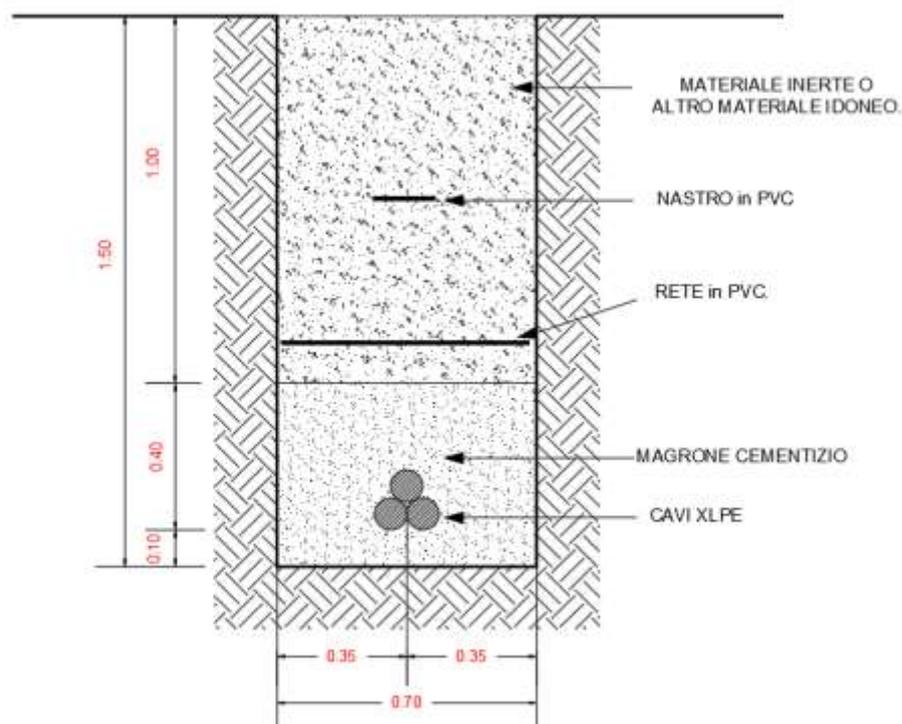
sezione tipica scavo e posa su terreno agricolo.
